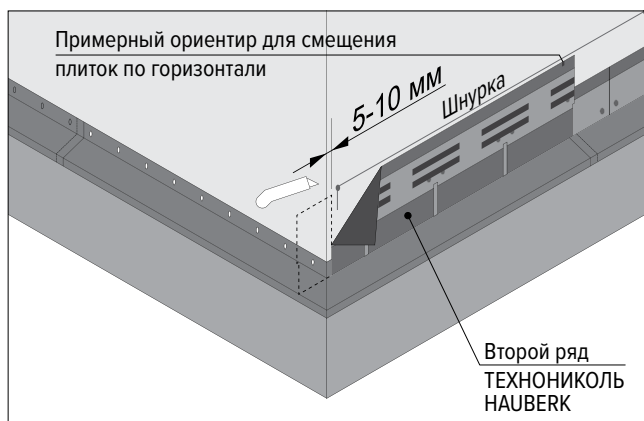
Монтаж первого и последующих рядов фасадной плитки
